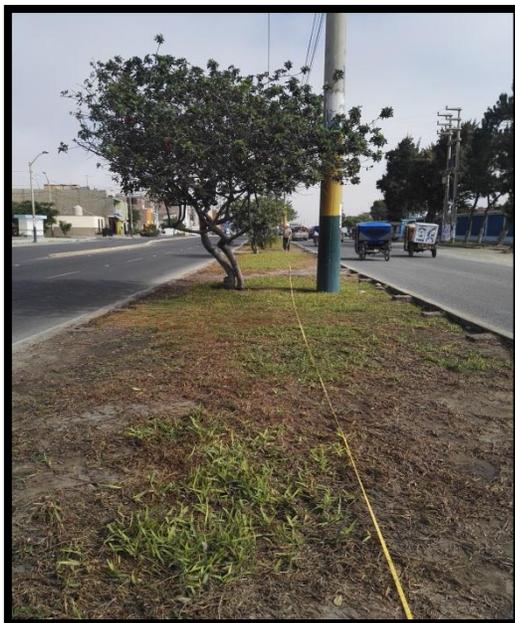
Medición insitu de berma central Avenida Anchoqueta
